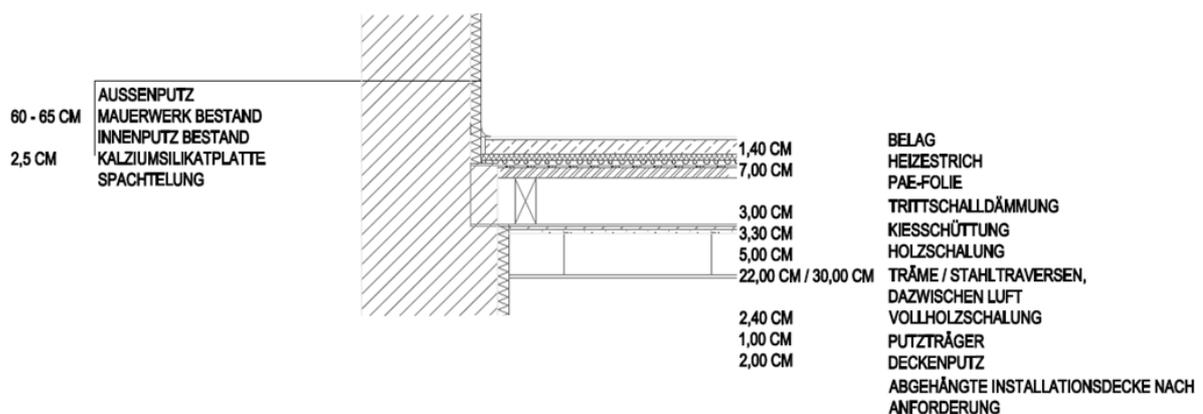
Tramtraversendecke – Konstruktionsdetail im Regelgeschoß (Quelle: Architekten Kronreif\_Trimmel & Partner, angepasst durch Schöberl & Pöll GmbH)
